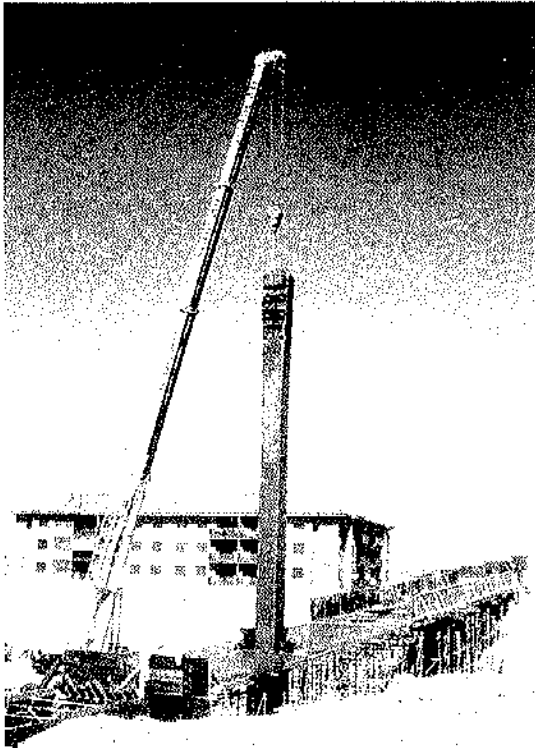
Colocación de la torre sobre la pila. Montaje de cimbra y encofrado.
